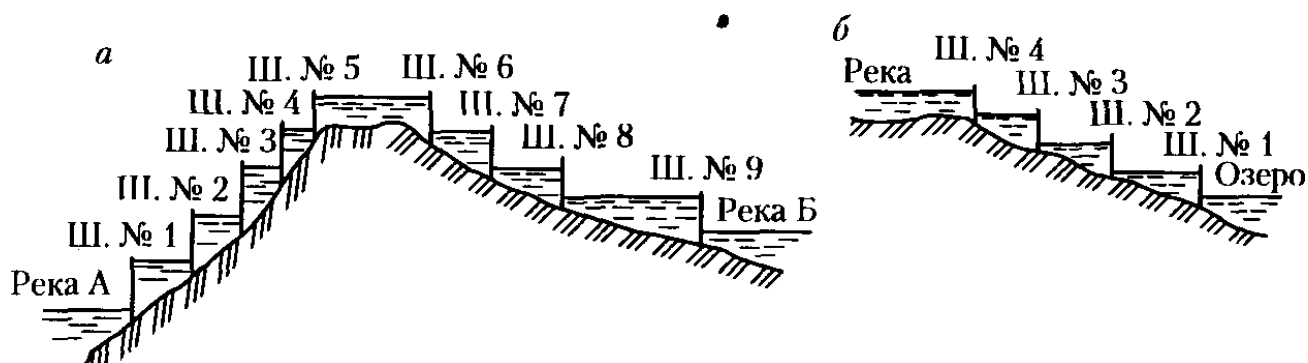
Схемы шлюзованных каналов: а – двухсклонная; б – односклонная (Ш. – шлюз)
